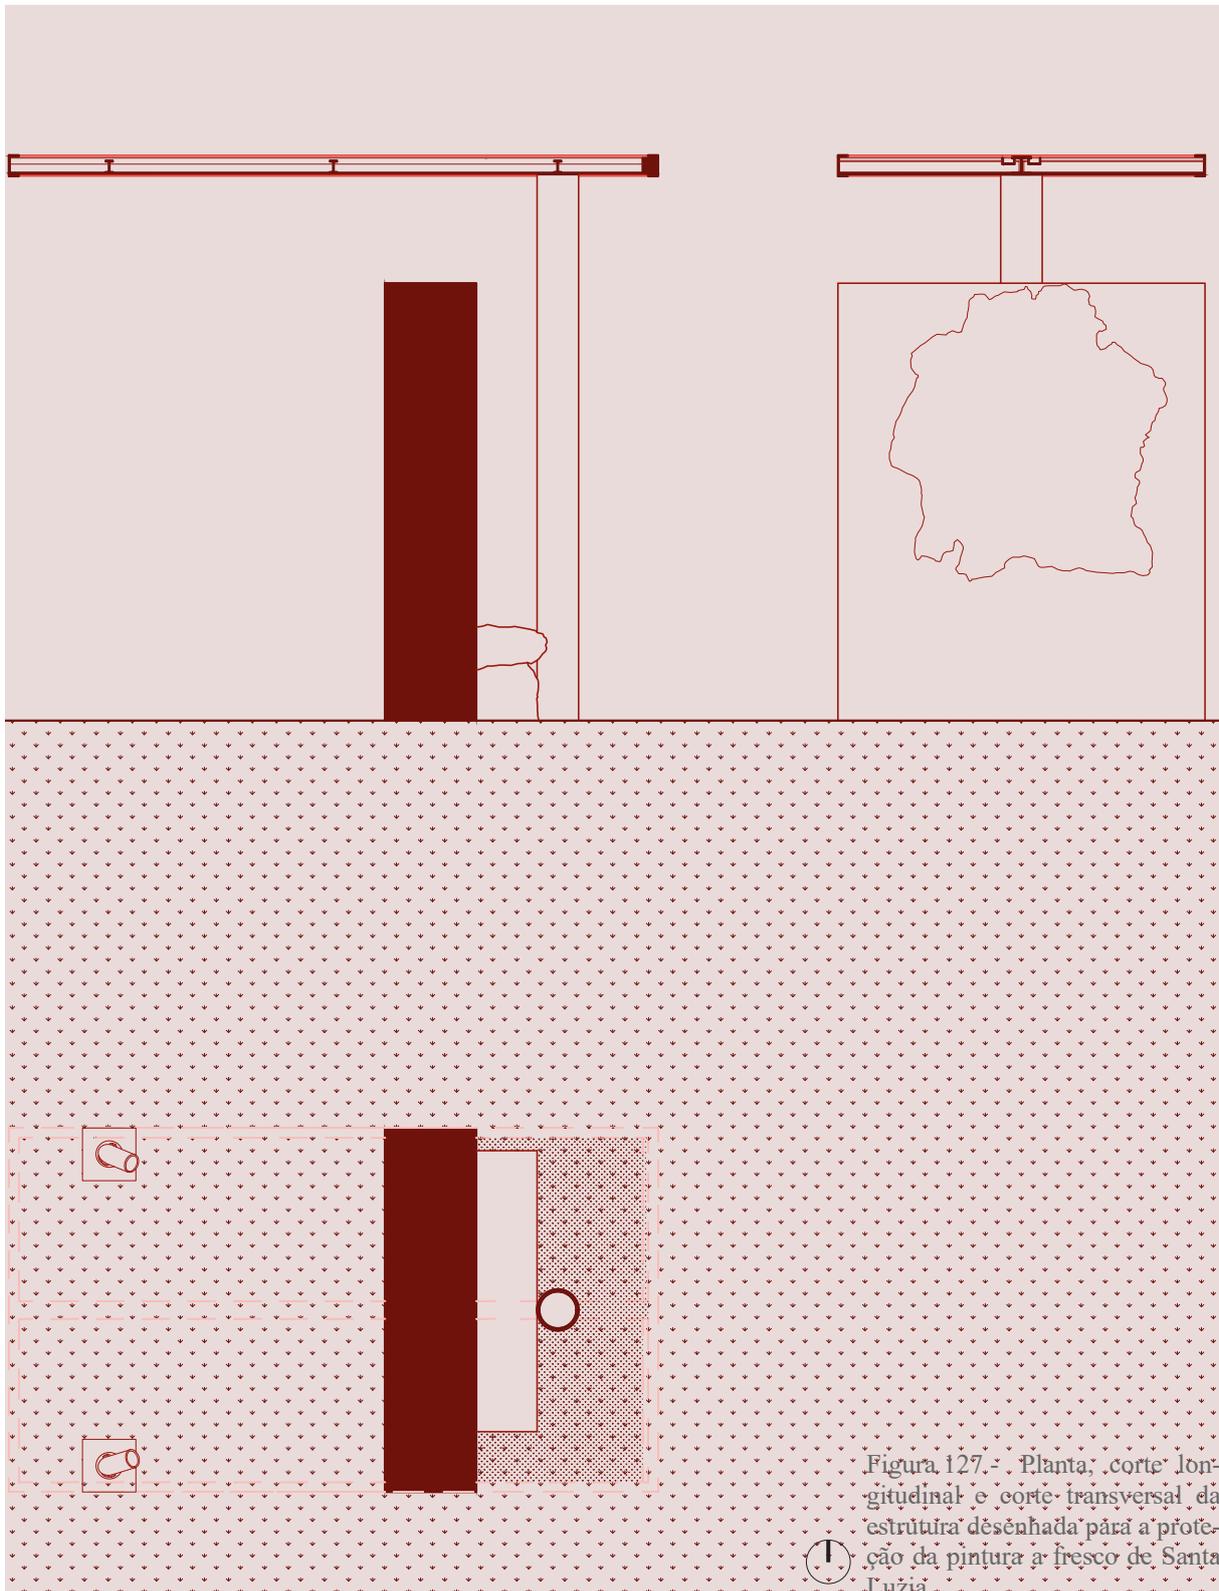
Planta, corte longitudinal e corte transversal da estrutura desenhada para a proteção da pintura a fresco de Santa Luzia
